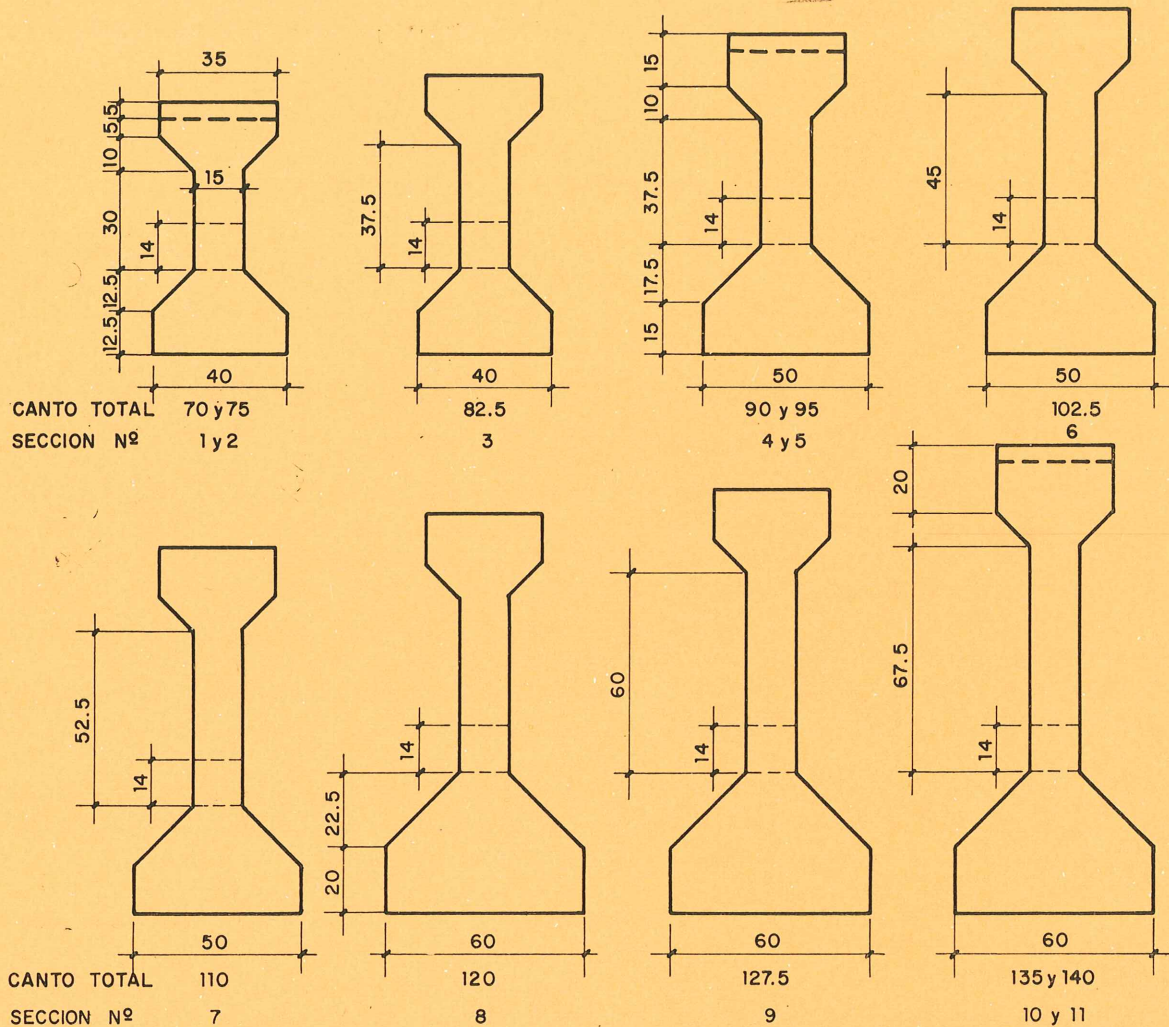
Detalle de las vigas tipificadas, de sección en I números 1 a 11. Todas las dimensiones se dan en centímetros.
